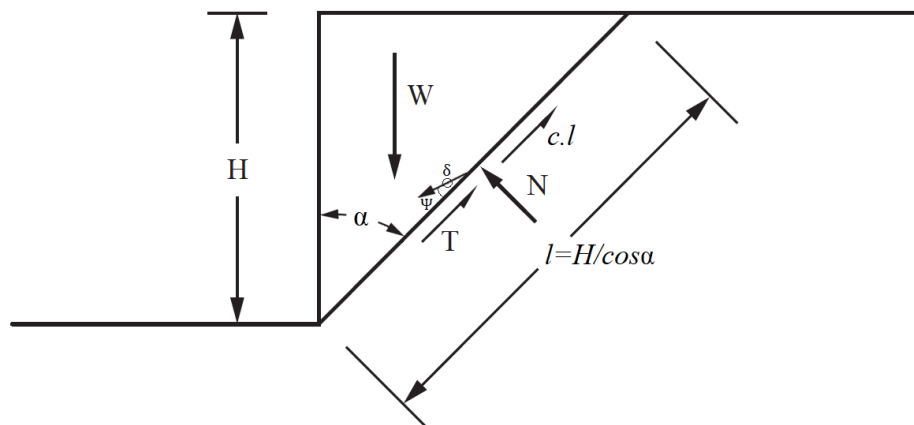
Superfície de deslizamento plana numa escavação de face vertical (adaptado de Duncan *et al*, 2014)
